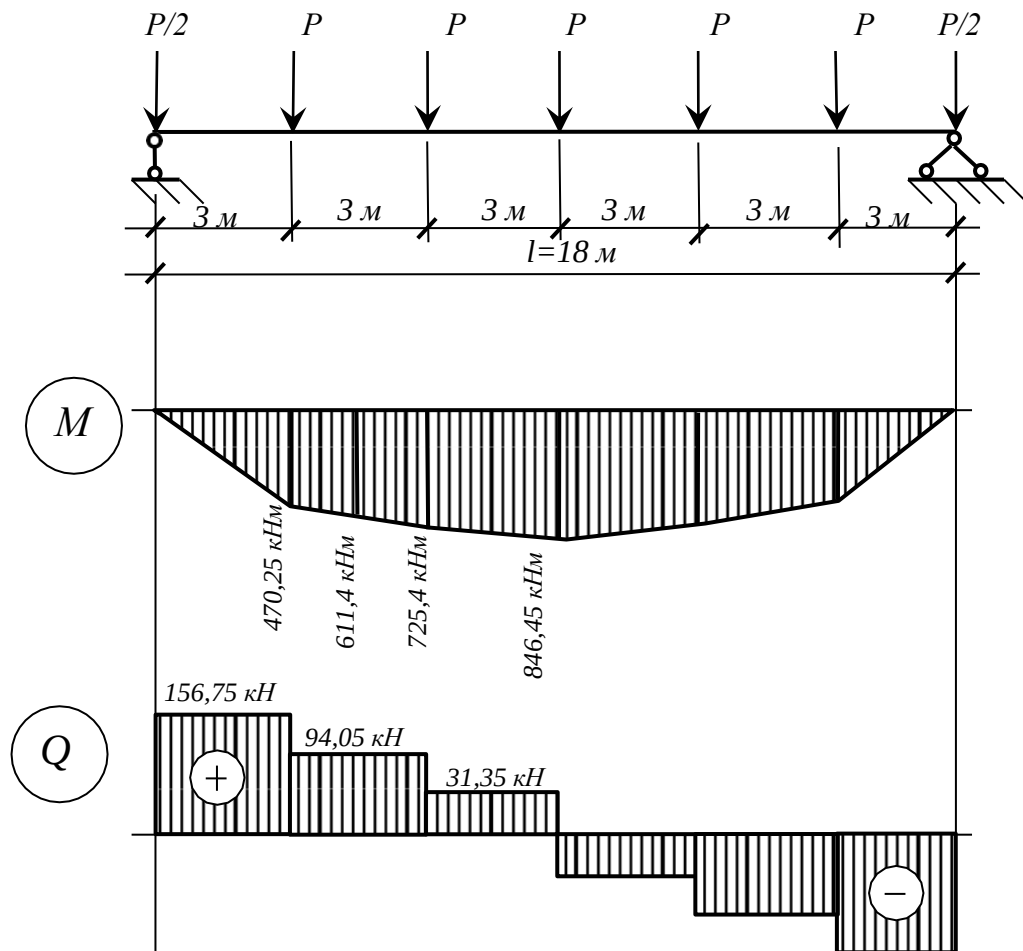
Расчетная схема стропильной балки покрытия и эпюры внутренних усилий M и Q
